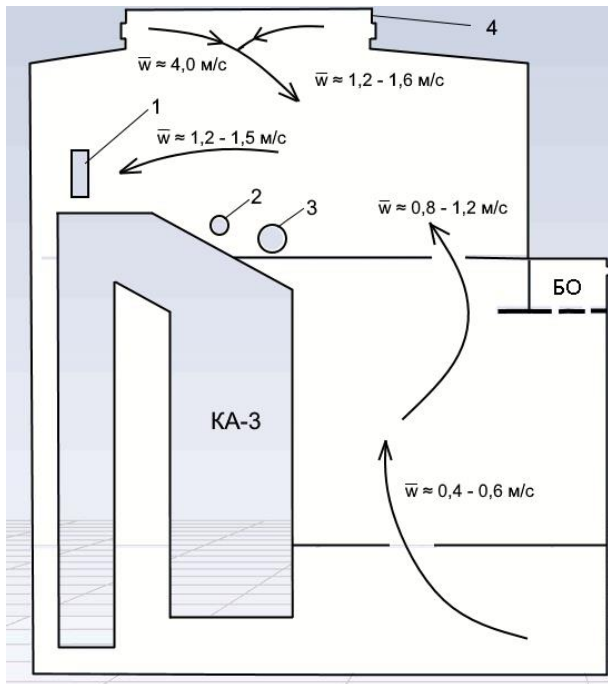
Скорость движения воздуха около котлоагрегата №3 при заборе воздуха из котельного отделения: 1 – забор воздуха на горение; 2 – второй барабан котлоагрегата; 3 – первый барабан котлоагрегата; 4 – аэрационный фонарь; КА-3 – котлоагрегат №3; БО – бункерное отделение
